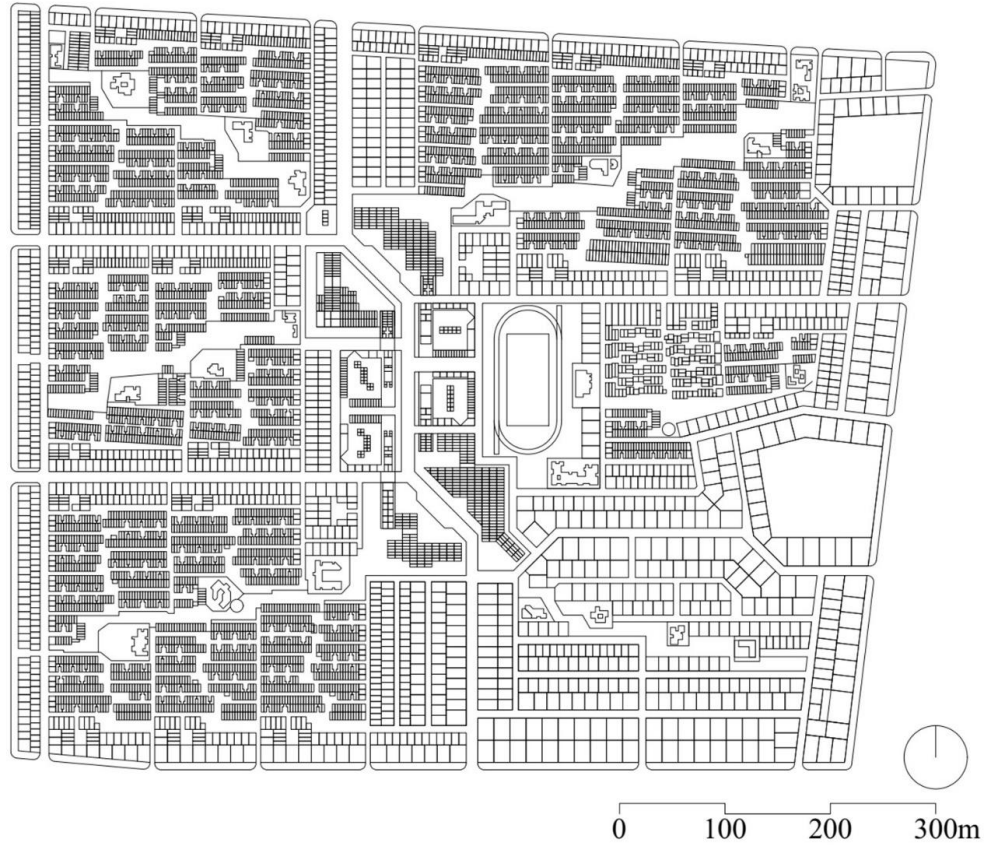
ATIRA & PRL Konutları, blok planı
